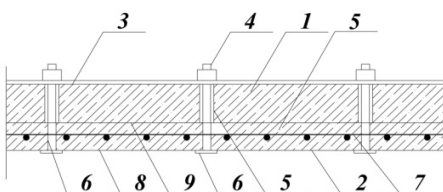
Устройство железобетонного наращивания снизу плиты при недостаточном сцеплении нового бетона со старым [1]:
